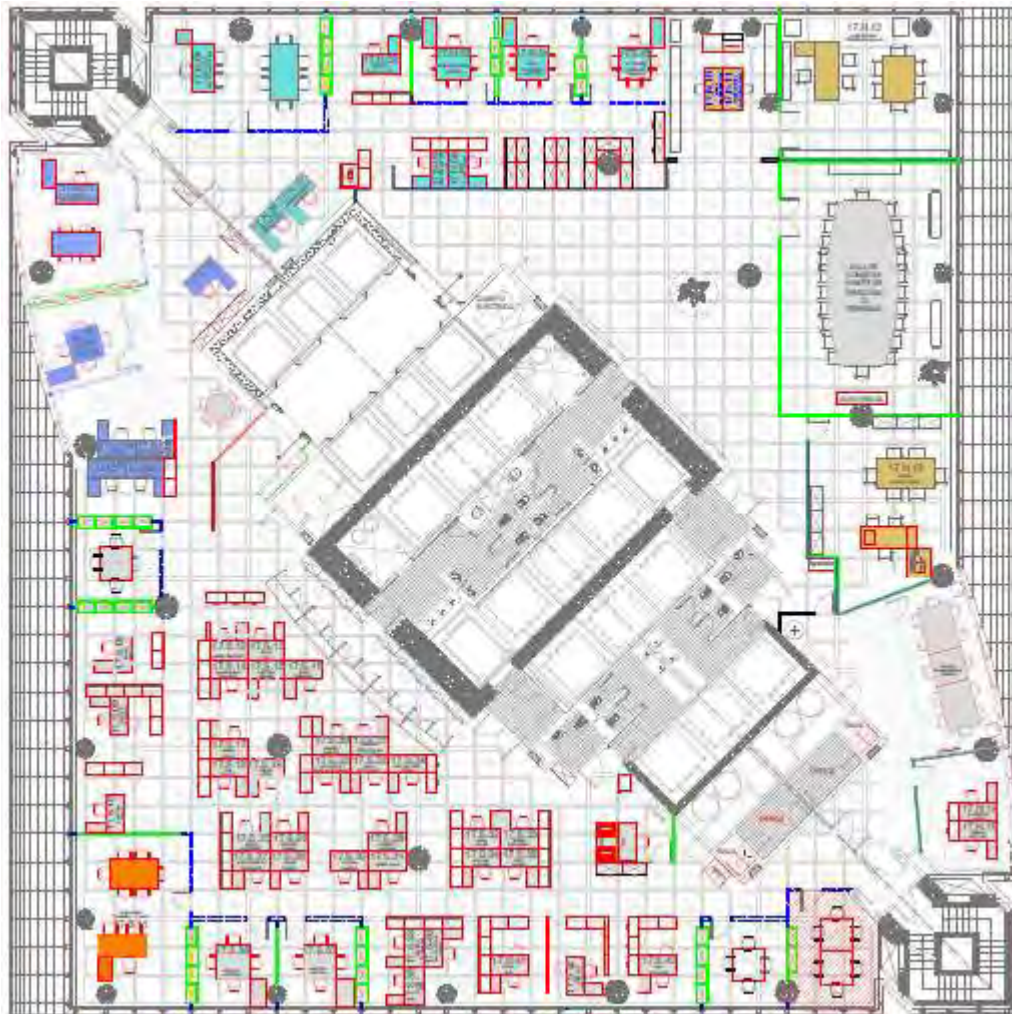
Plano planta Diecisiete edificio Torre Espacio
